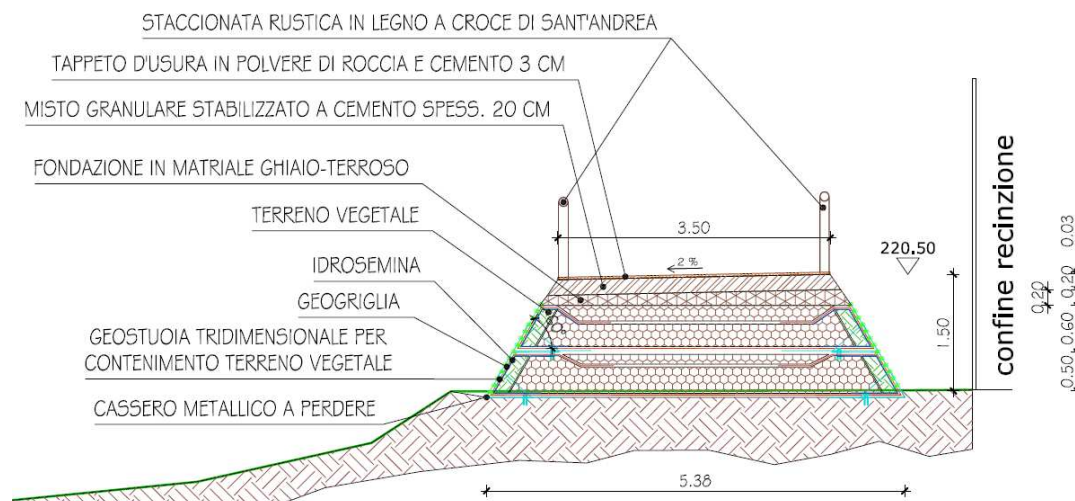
Sezione tipo della pista ciclabile con terre rinforzate
